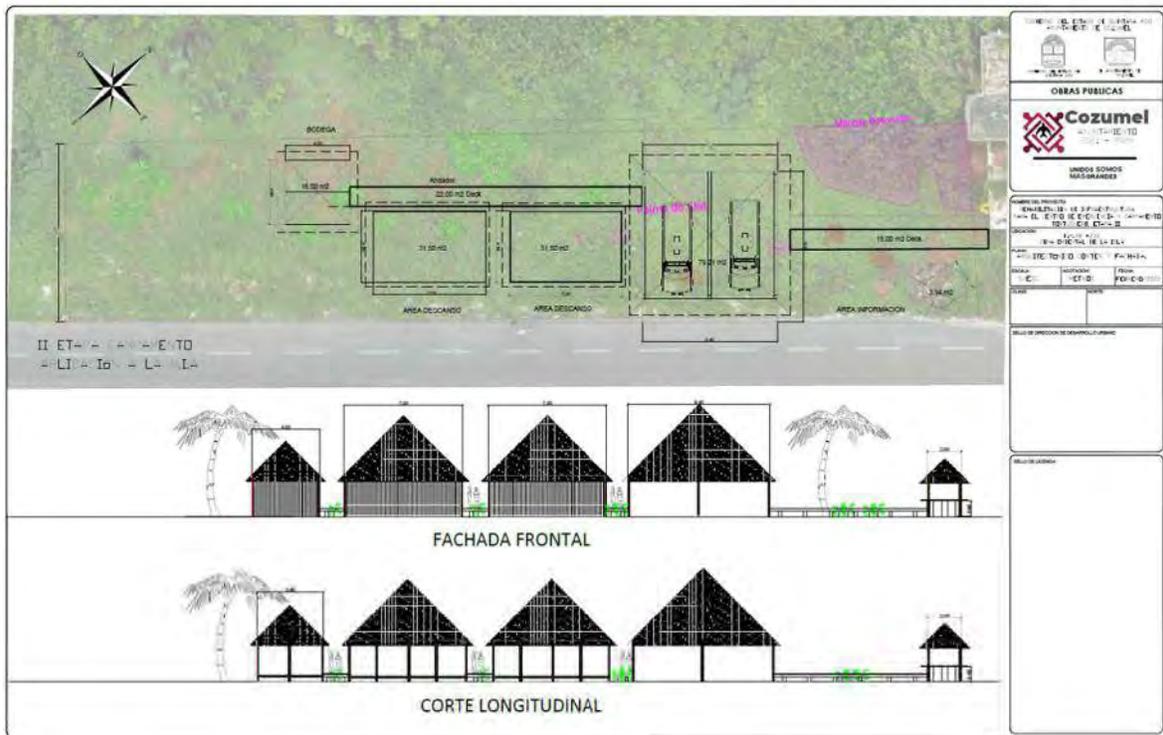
Plano de las fachadas frontal y longitudinal de la infraestructura del proyecto.
